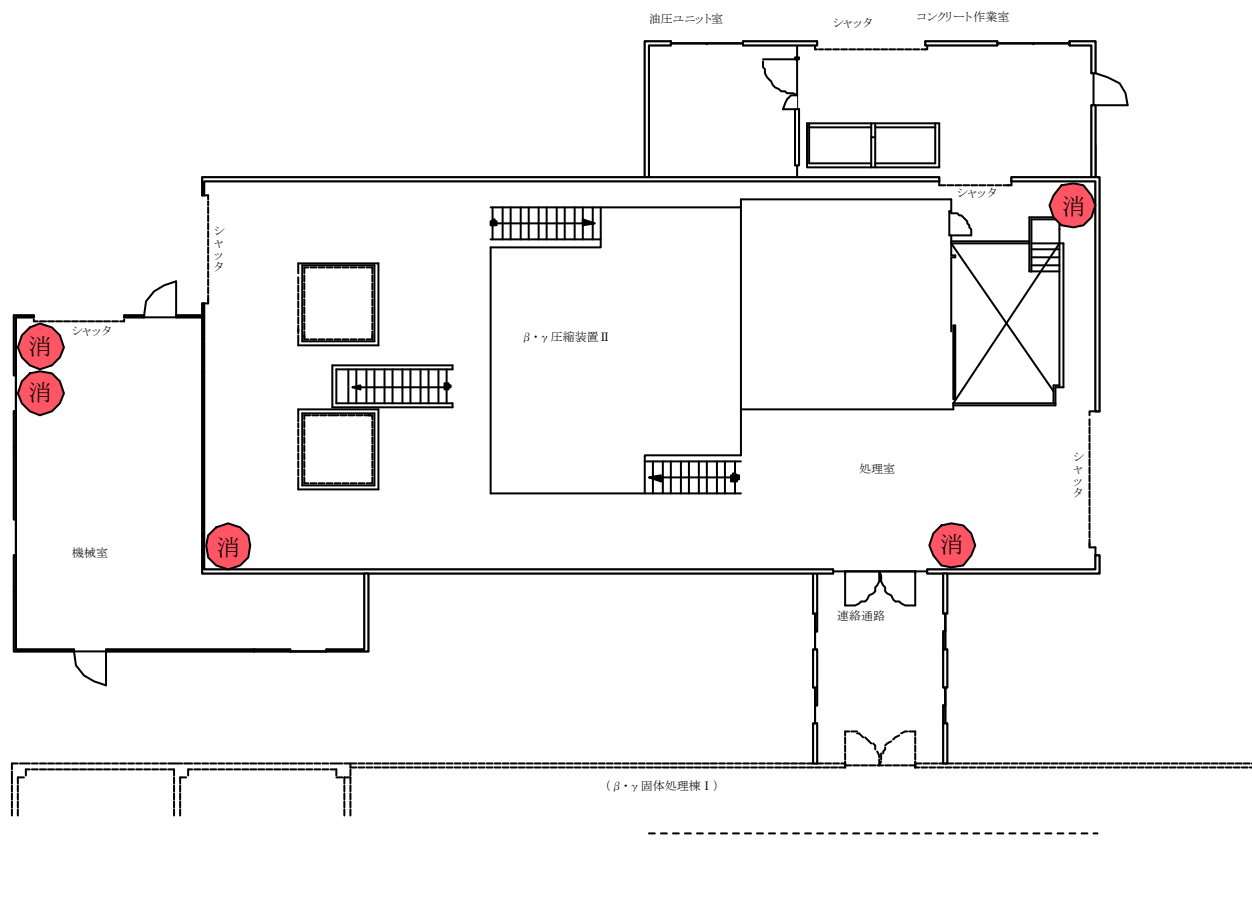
β・γ固体処理棟Ⅱ（β・γ一時格納庫Ⅱ）1階平面図
